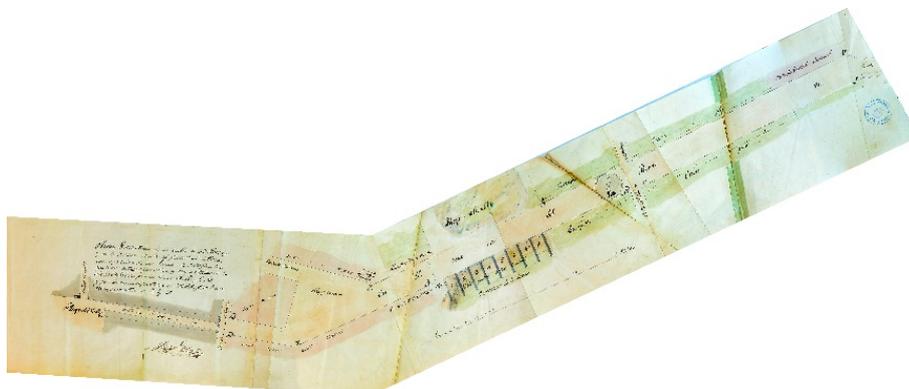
Plano de la calle San Lorenzo y la del Puente (1844, AMA)
